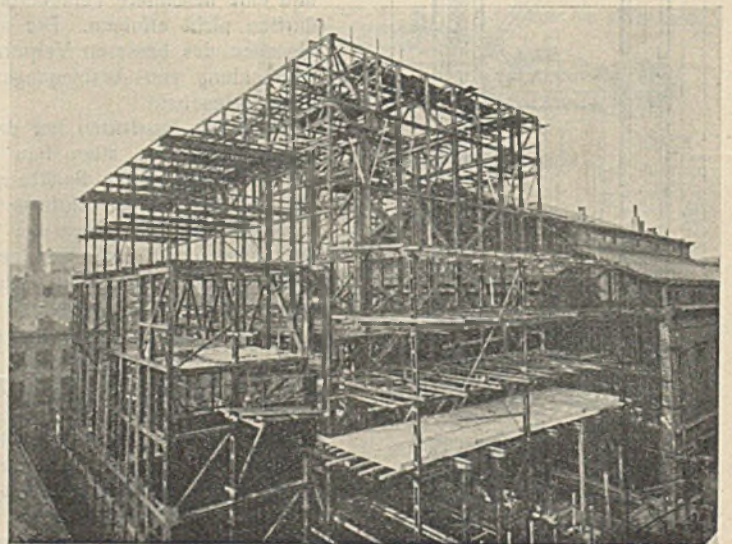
Stahlkonstruktion in der Aufstellung vor Ausmauerung.
